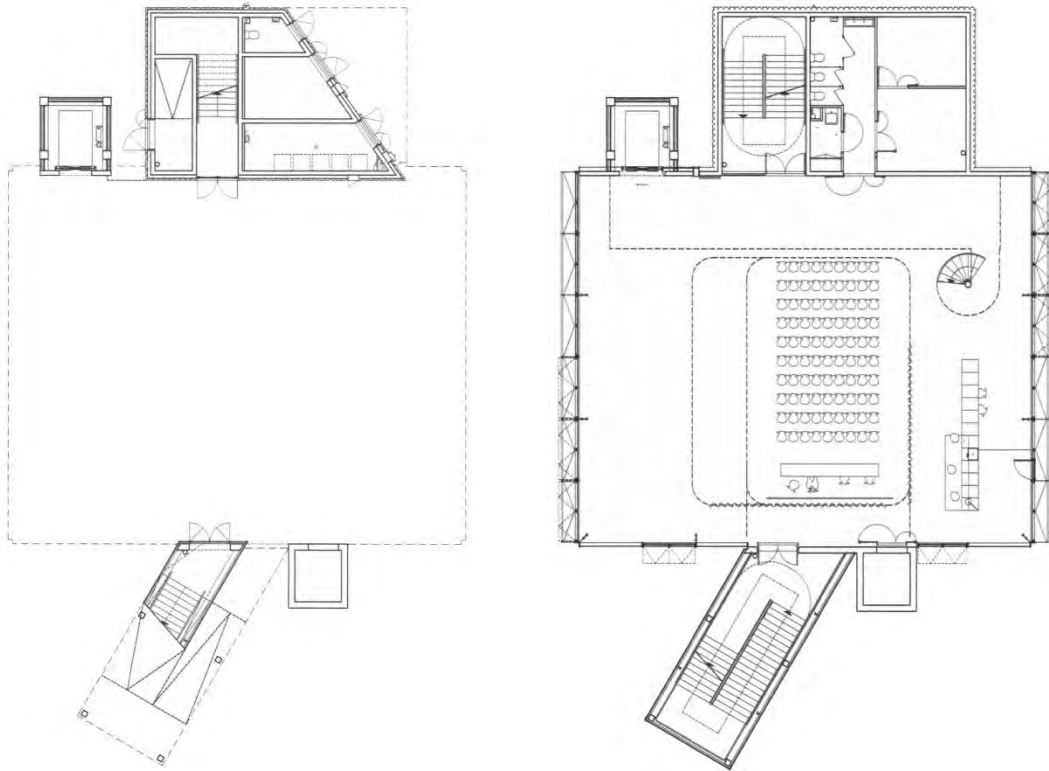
Planta baja y planta primera de Le Dôme, 2013-2015
